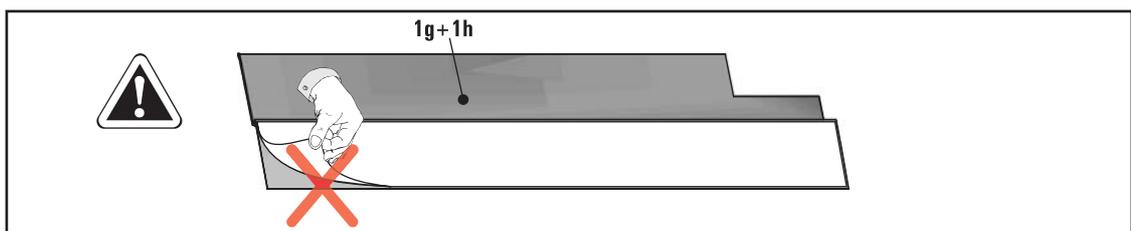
Rimuovere la pellicola di copertura delle strisce bituminose solo dopo aver montato tutti i collettori piani nel processo di copertura (sezione 3.4.9)!
